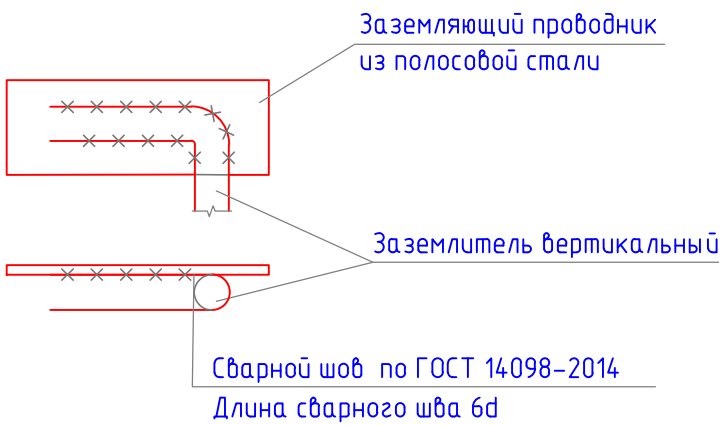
Сварное соединение полосового и вертикального заземлителя
